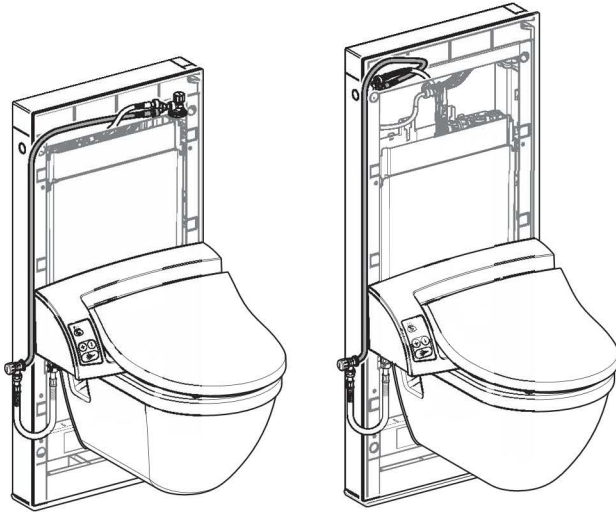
Seitlicher Wasseranschluss am Geberit Monolith (links Bauhöhe 101 cm, rechts Bauhöhe 114 cm)
